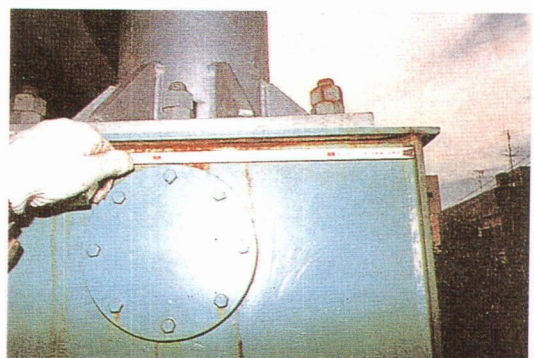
上フランジと化粧板との溶接部のわれ
